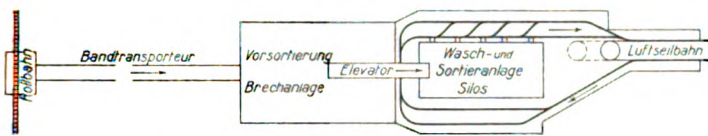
Schematischer Grundriss der Kiesaufbereitungs-Anlage. — 1 : 900.
